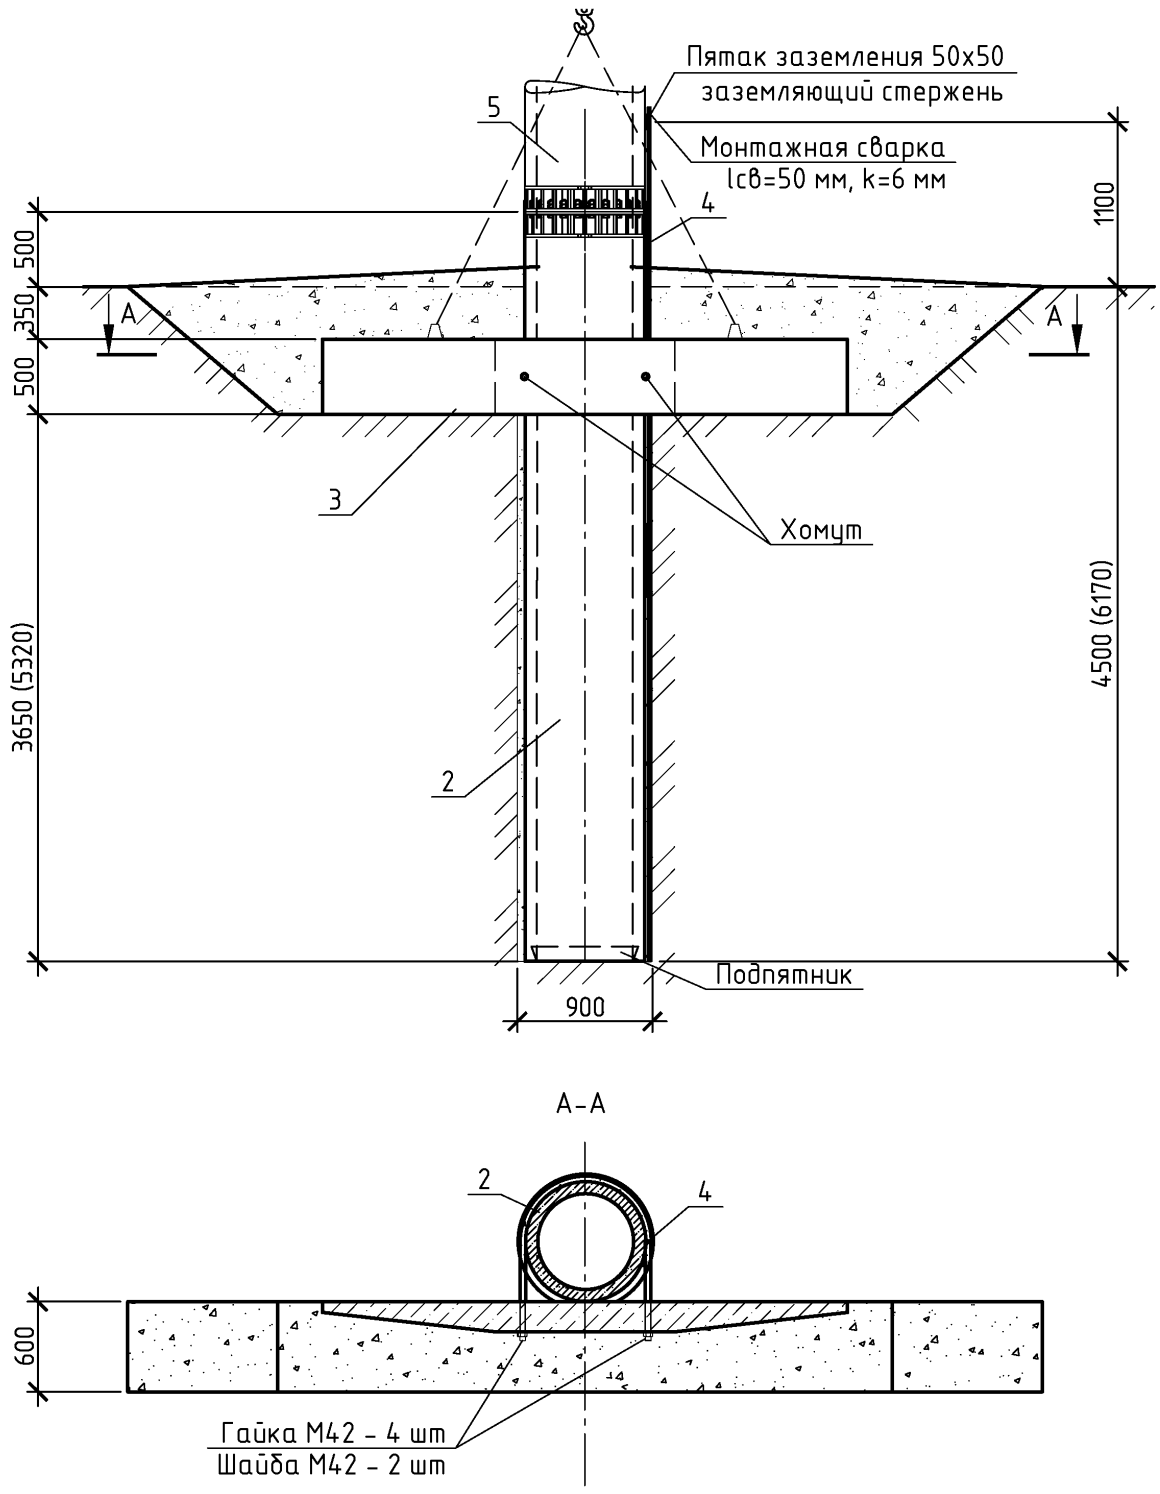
Схема установки ригеля при закреплении анкерно-угловых опор
